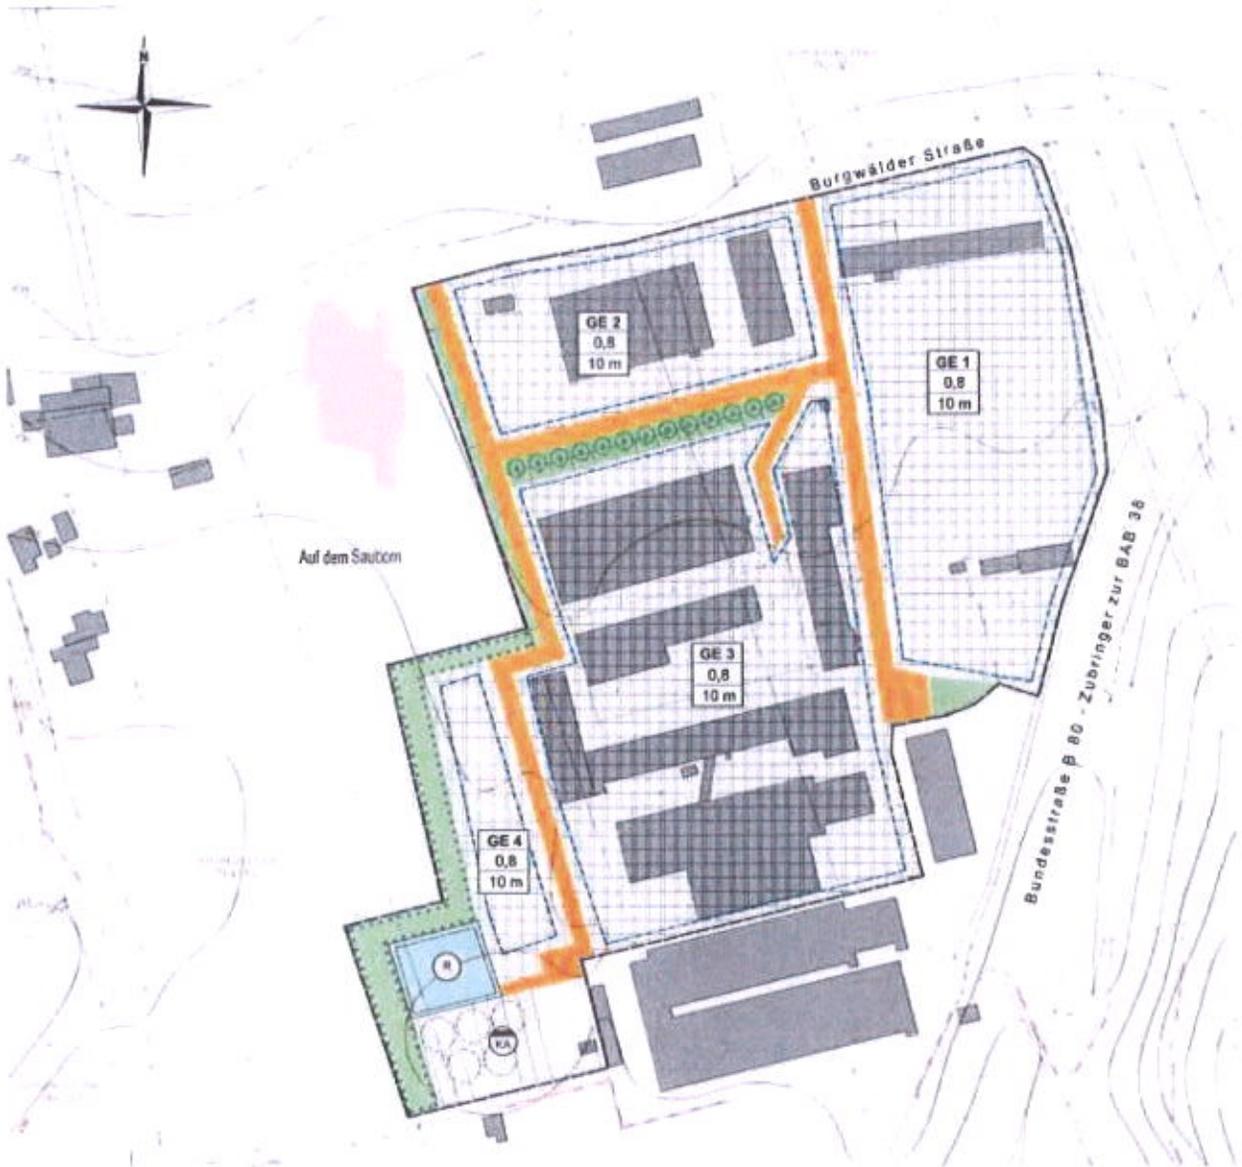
Lageplan Bebauungsplan Nr. 4 „Auf dem Sauborn“ in Marth
